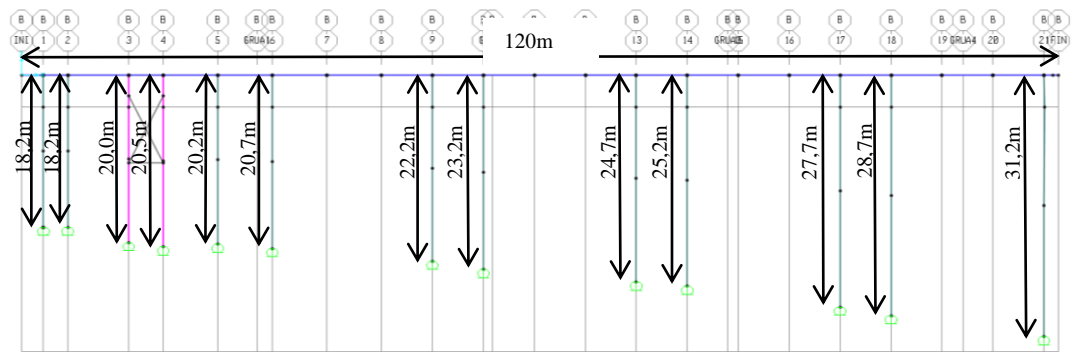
Vista en elevación del plano B de geometría, paralelo a plano X-Vertical'.
